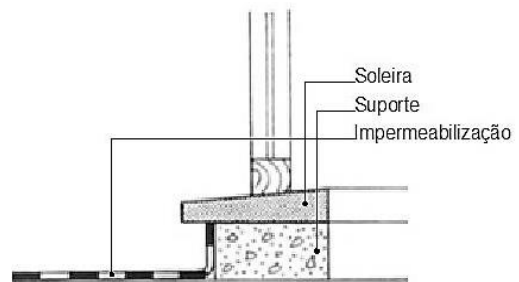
Pormenor errado de uma soleira (adaptado de Lopes, 2010)
